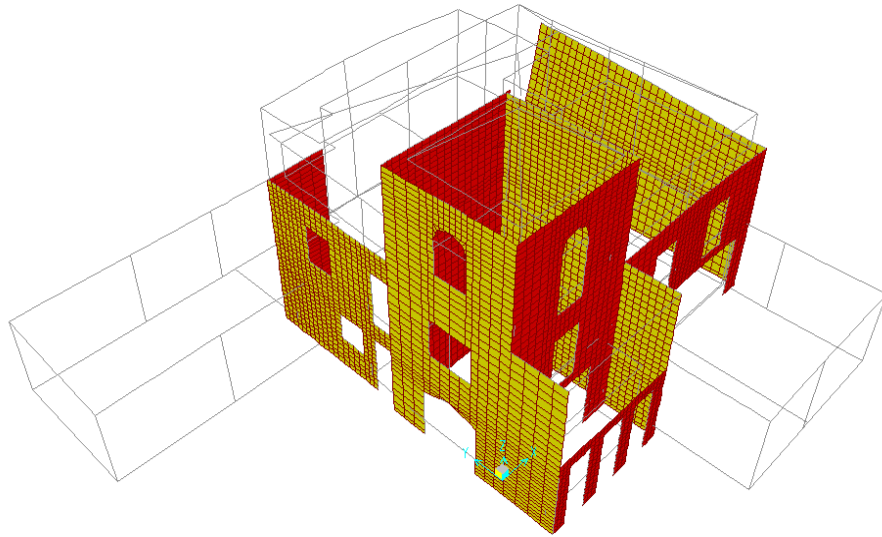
Deformada da estrutura a actuar segundo a direcção longitudinal (eixo X)
